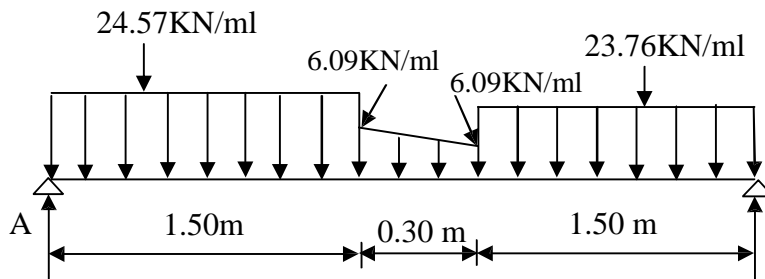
Schéma statique de la poutre brisée à l'ELS
